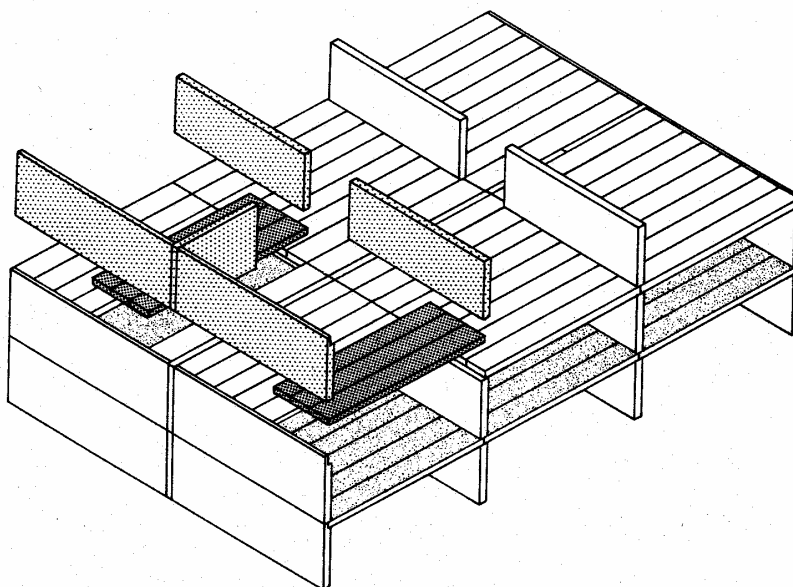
esquema da construção com paredes portantes perpendiculares à fachada.
